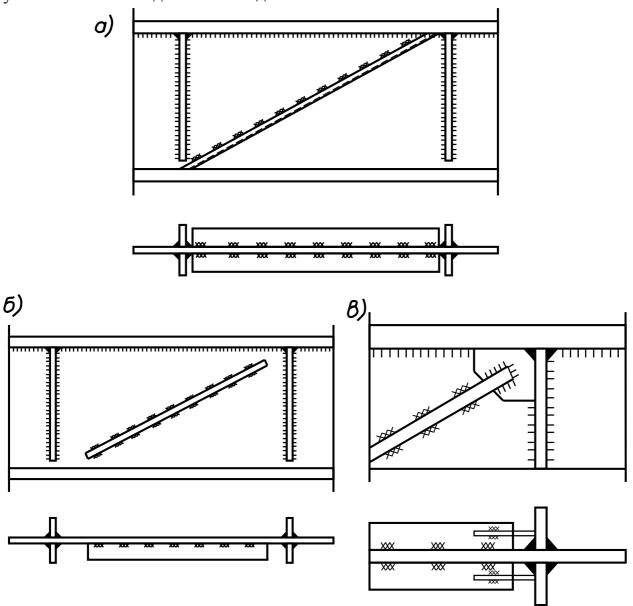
Способы обеспечения устойчивости стенки балки: а) наклонными ребрами с пригонкой к поясам; б) наклонными ребрами без пригонки к поясам; в) диагональными ребрами, пригнанными к поясам.
